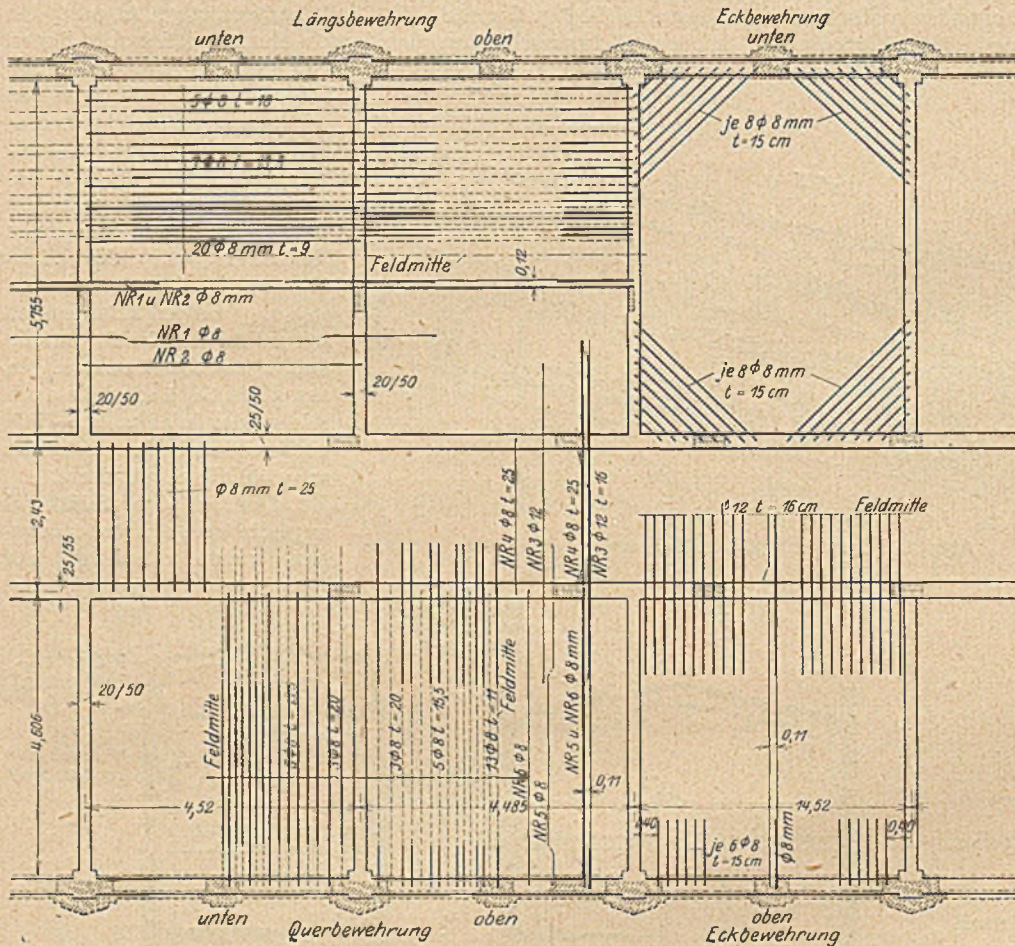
Bewehrung der Deckenplatten im Mittelbau.
